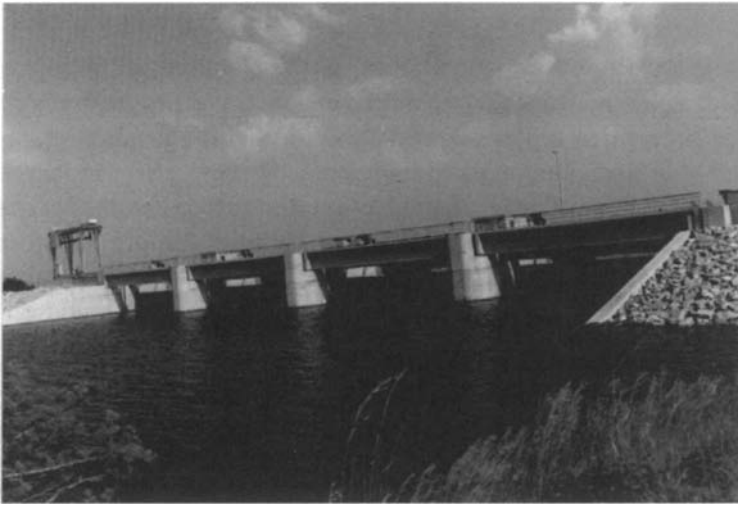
Plan d'eau du barrage de Bagré (Burkina Faso).
